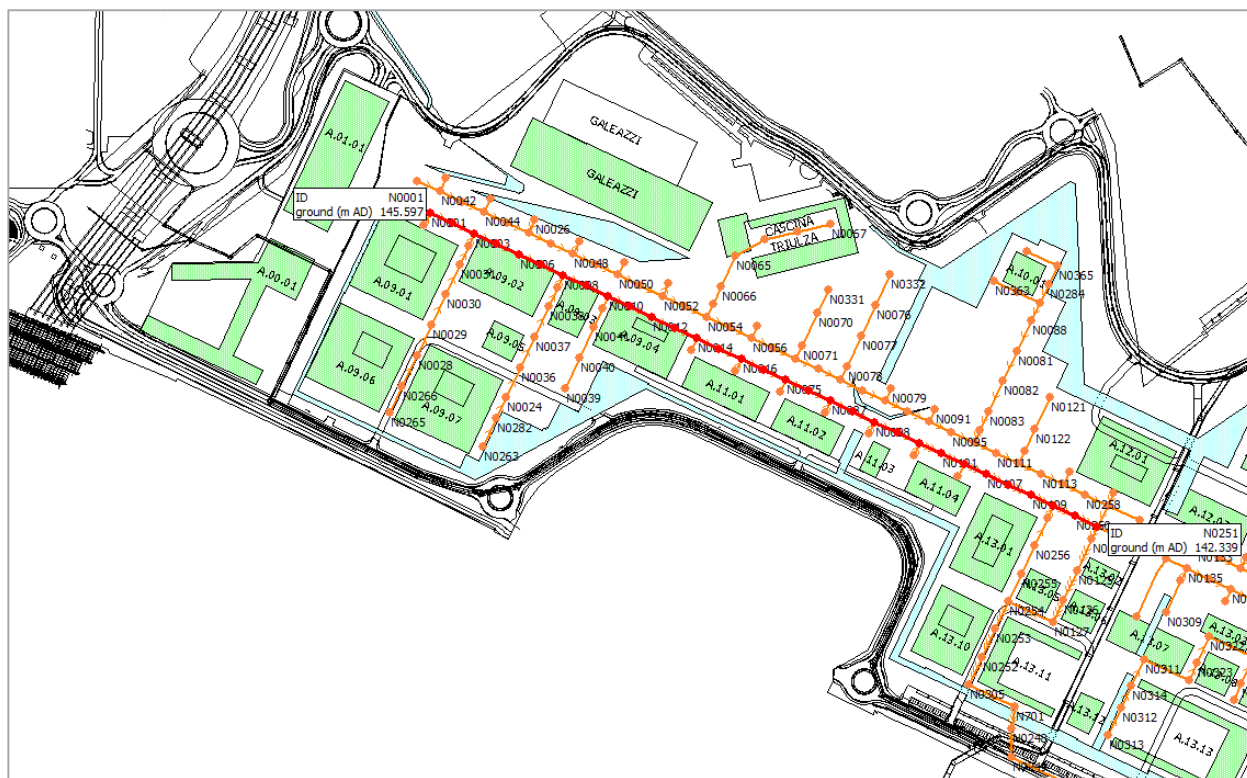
Stralcio planimetrico del tratto di profilo sopra riportato (in rosso i condotti selezionati)
